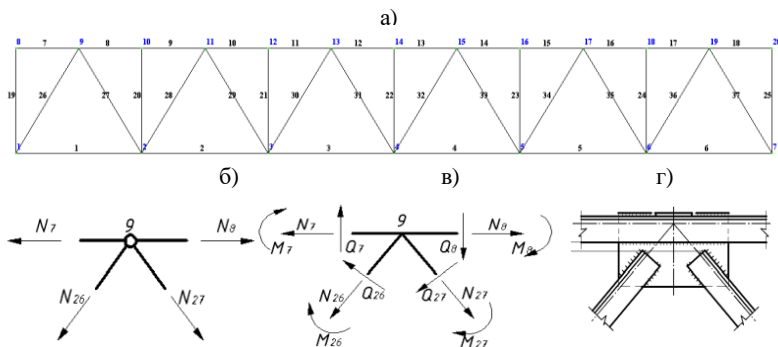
Ферма покрытия: а – геометрическая схема плоской фермы; б – усилия в шарнирном узле; в – усилия в жестком узле; г – узел стальной фермы
